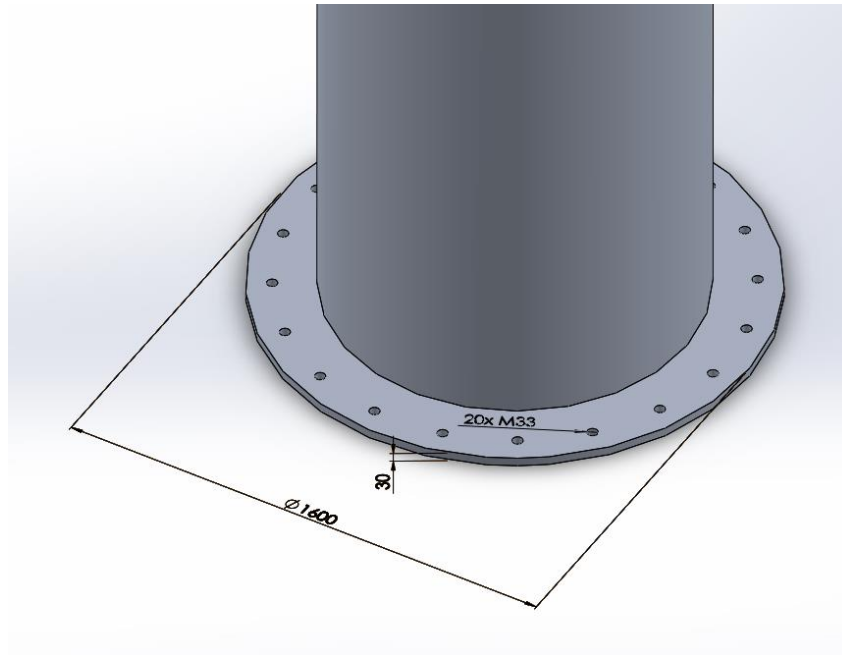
Dimensiones de la placa de anclaje de la columna.
